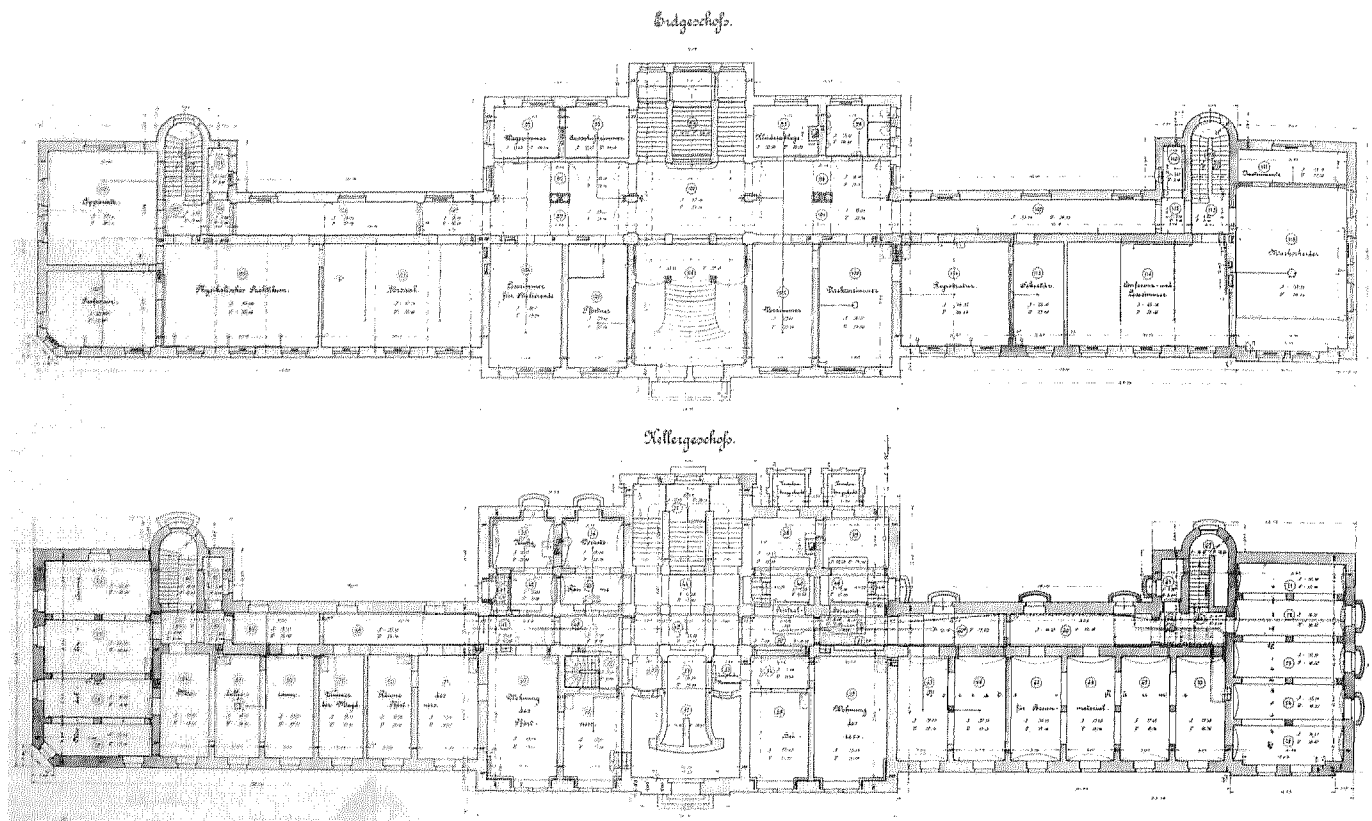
Raumaufteilung des Keller- und Erdgeschosses.
